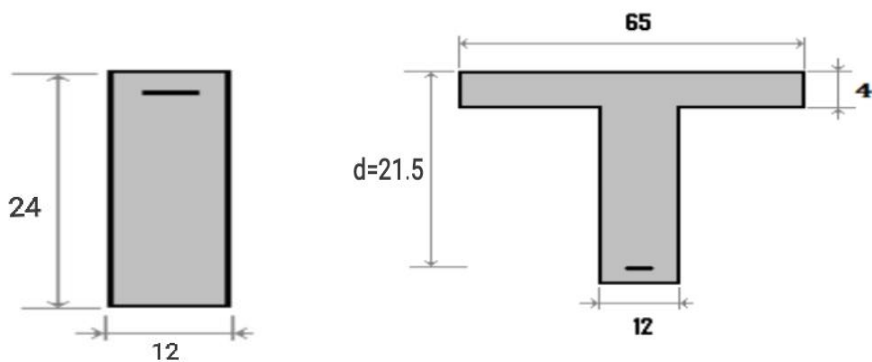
Les sections considérées pour le calcul des ferrailages
